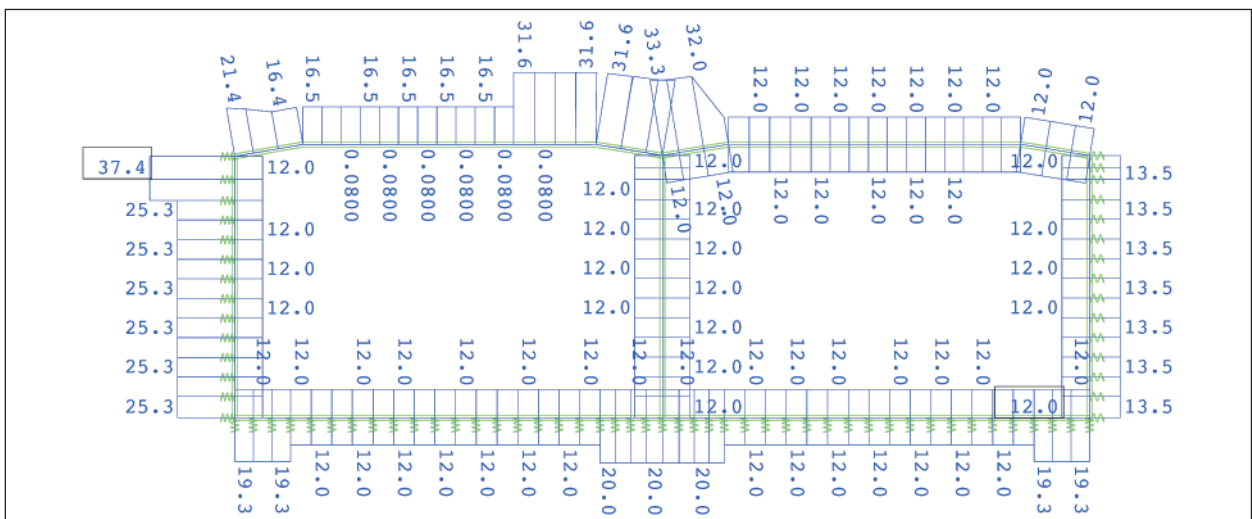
Erf. Bewehrung BQ 4 [cm²/m]
